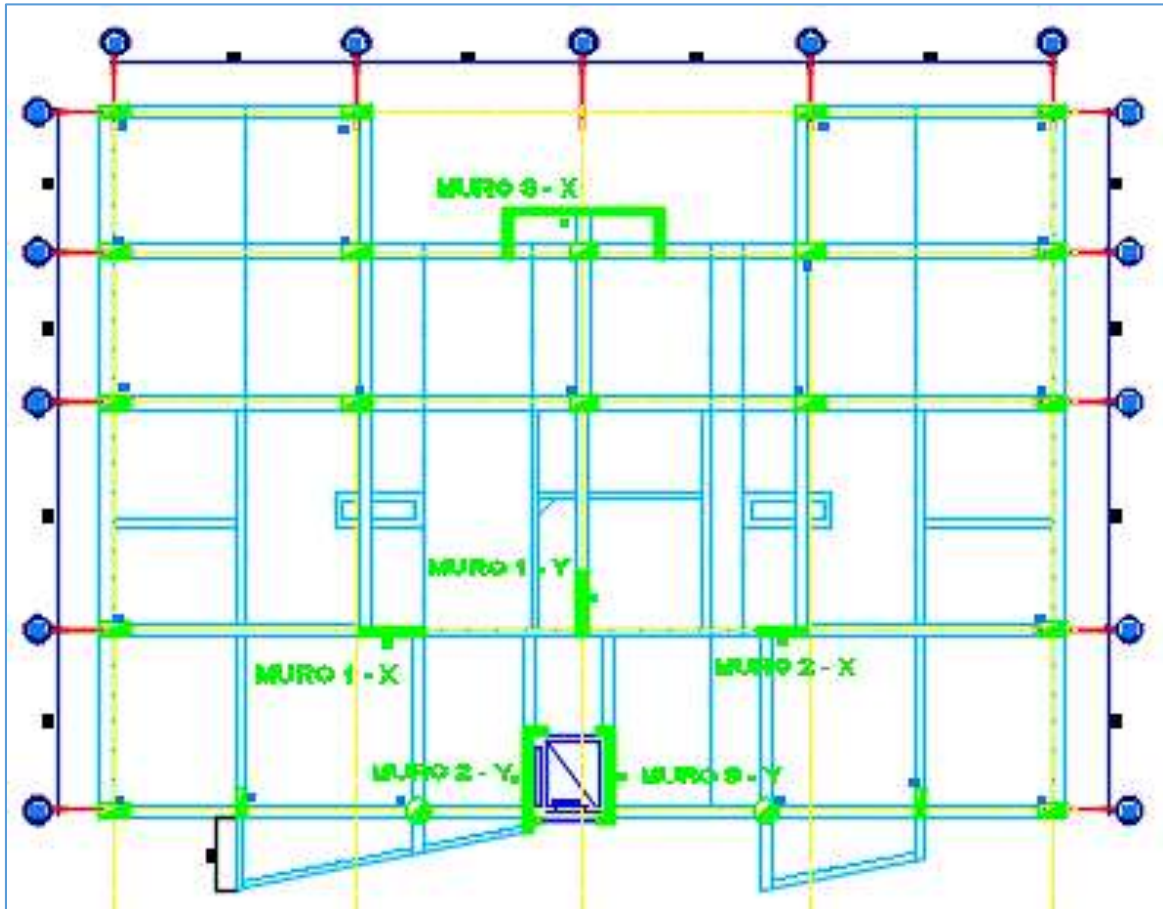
Ubicación de los elementos resistentes – Planta Típica
